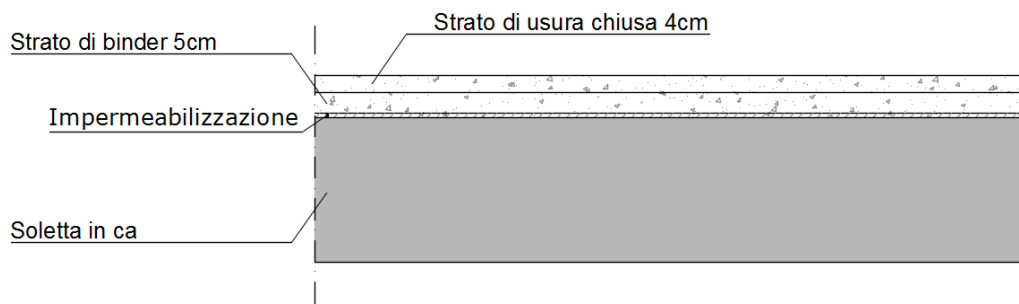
Composizione sovrastuttura viabilità principale su impalcato – TIPO P1B
